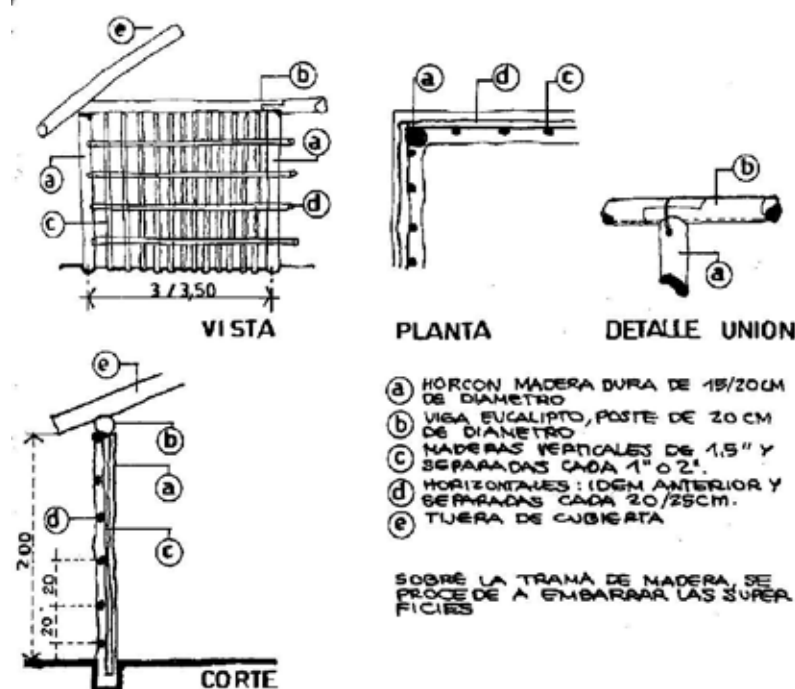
Muro de Estanteo (Salas 1990: 39)
